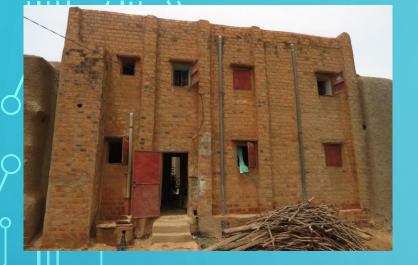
Djenné: vue sur une concession avec la façade habillée en pierre – Photo H.A. DIOP – Août 2017
